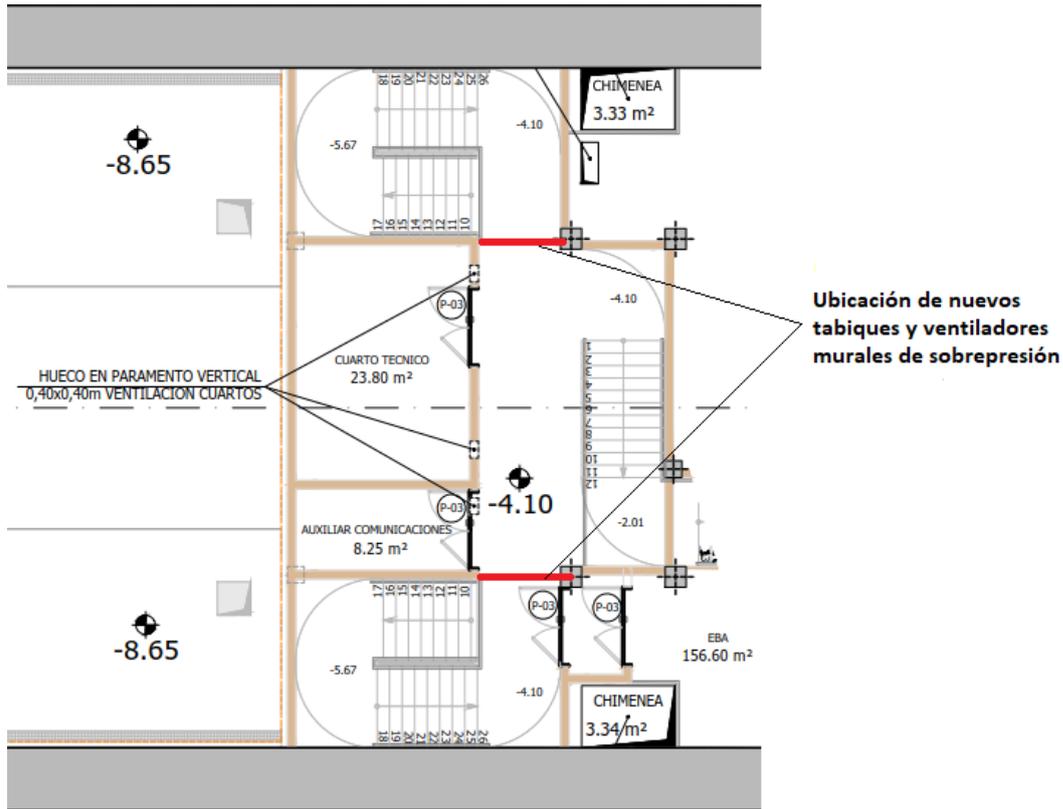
Detalles de ventilación de sobrepresión de Pasaia
